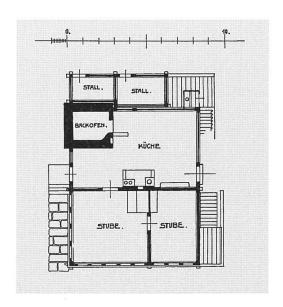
Grundriss eines Taunerhauses mit Kleinbäckerei
